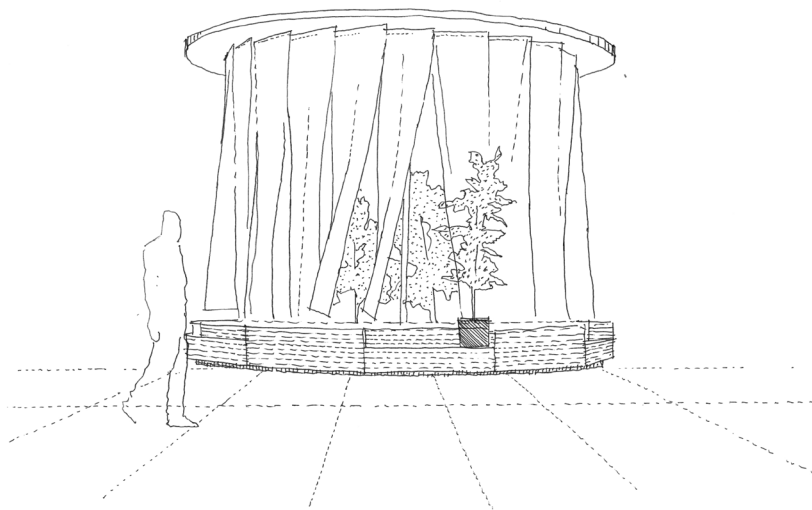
Breath Earth Collective, 2018, Airship.03, Fountain of air, Milano. Elaborazione dell'autore.
